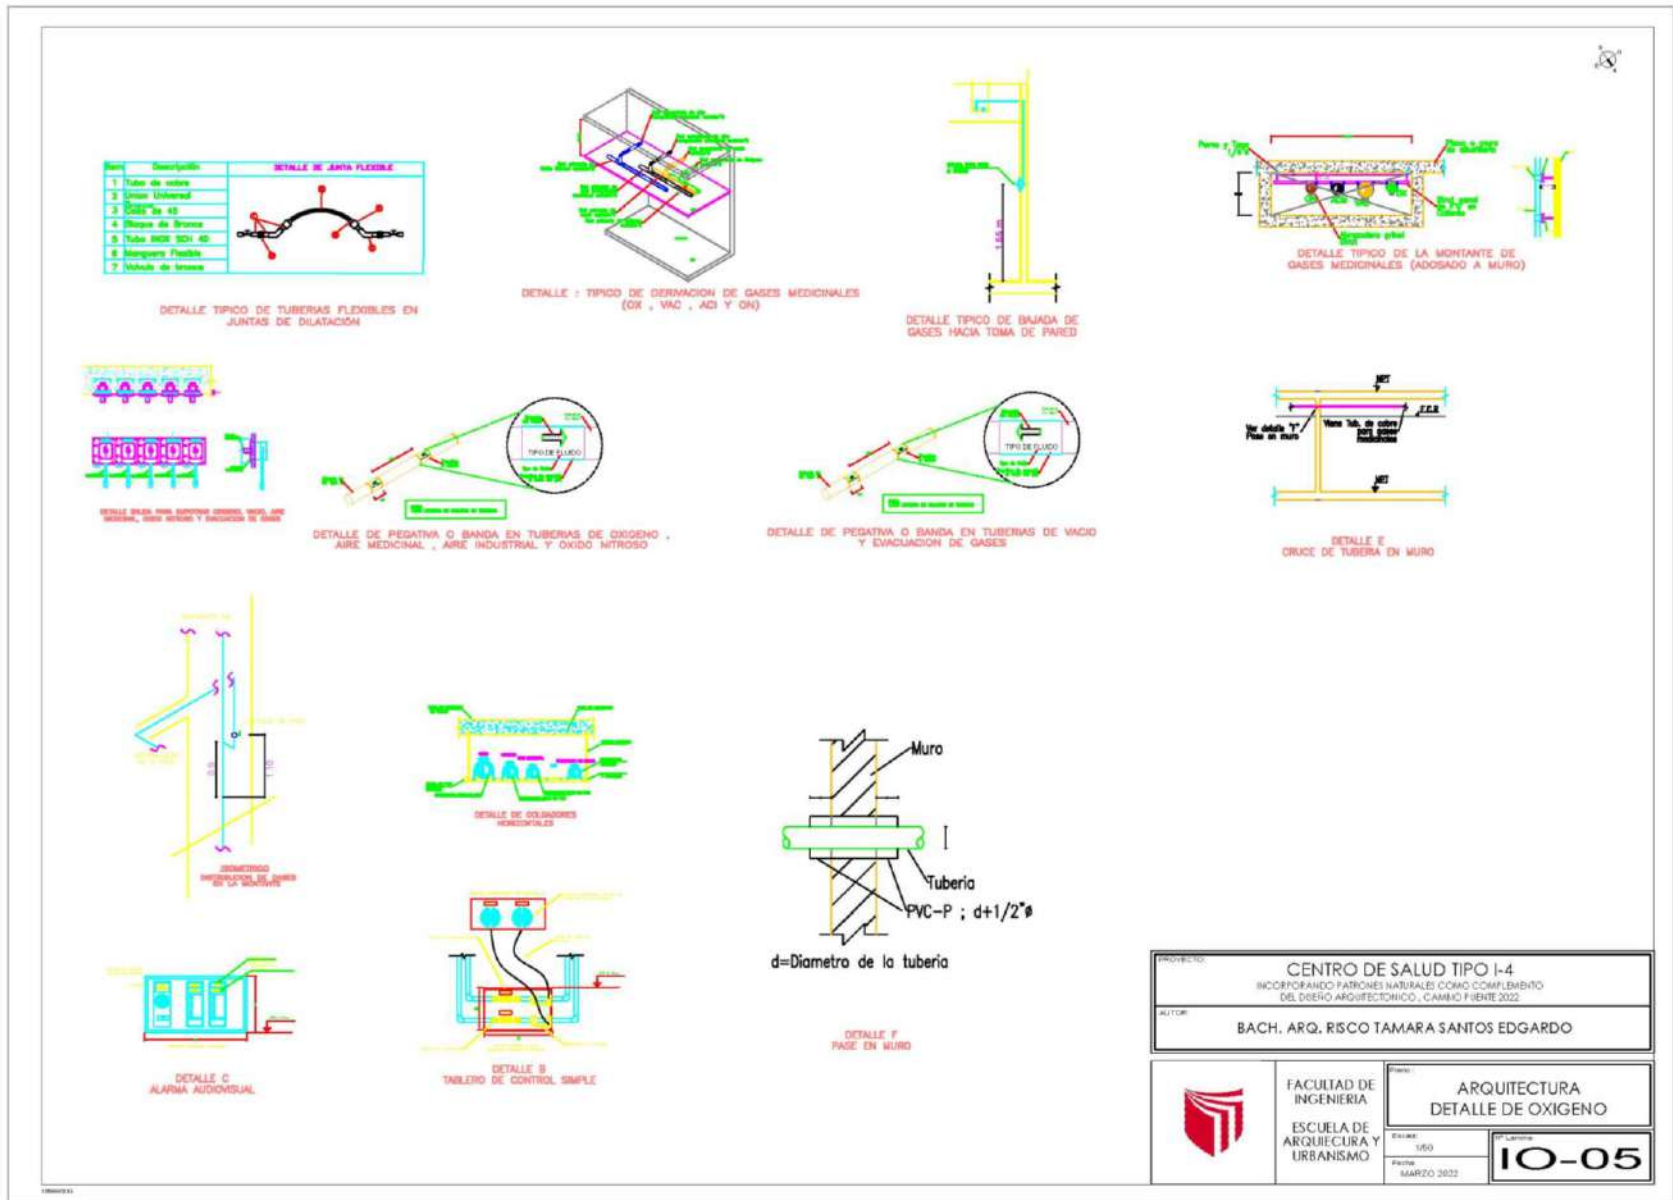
Plano Detalles de Instalaciones Red de Oxígeno.
